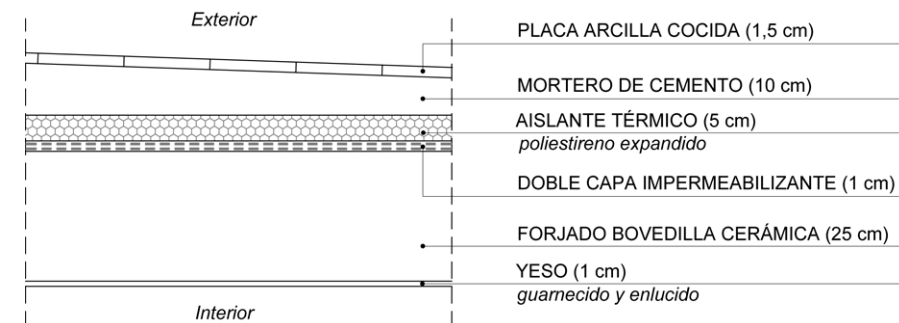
Detalle constructivo de la cubierta del modelo convencional.
